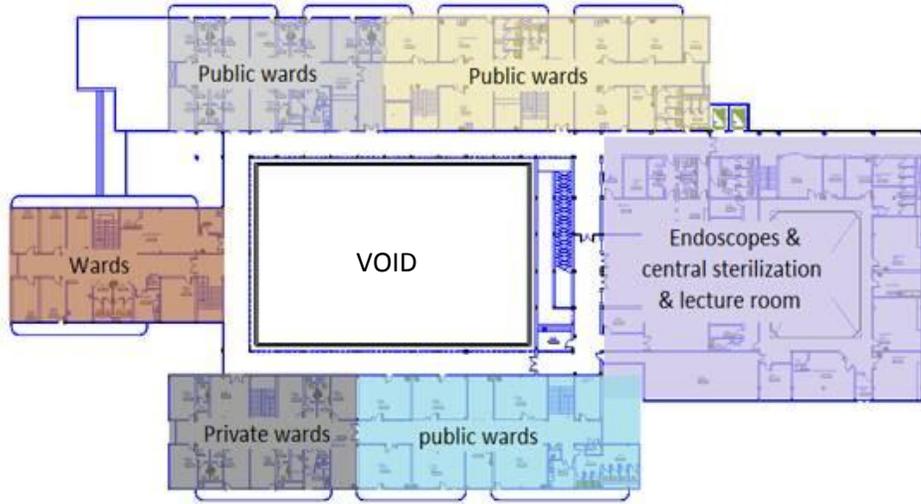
يوضح الطابق الأرضي لمستشفى شرق النيل
